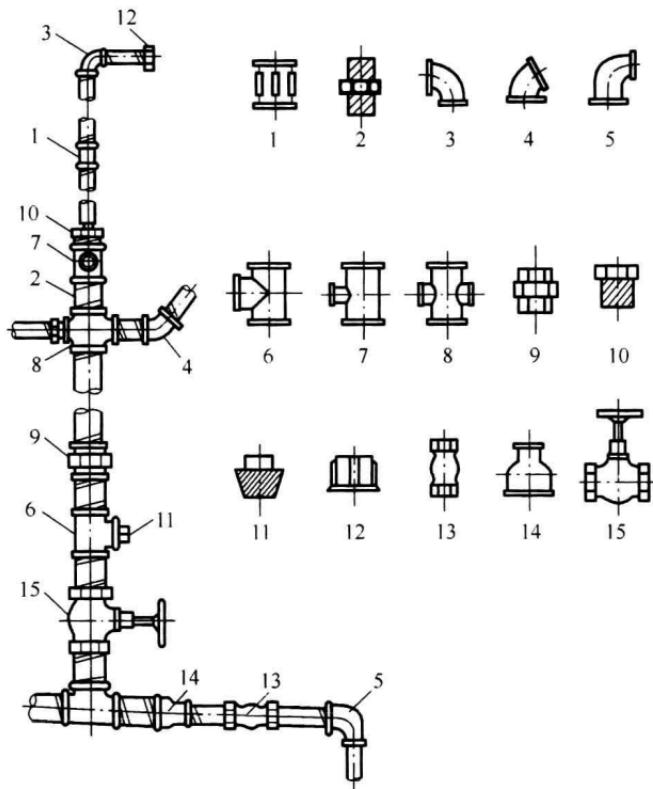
低压流体输送焊接钢管螺纹连接配件
